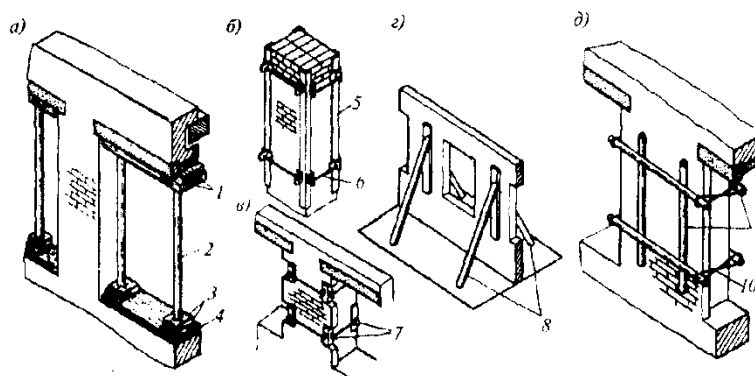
Усиление каменной кладки на период оттаивания
